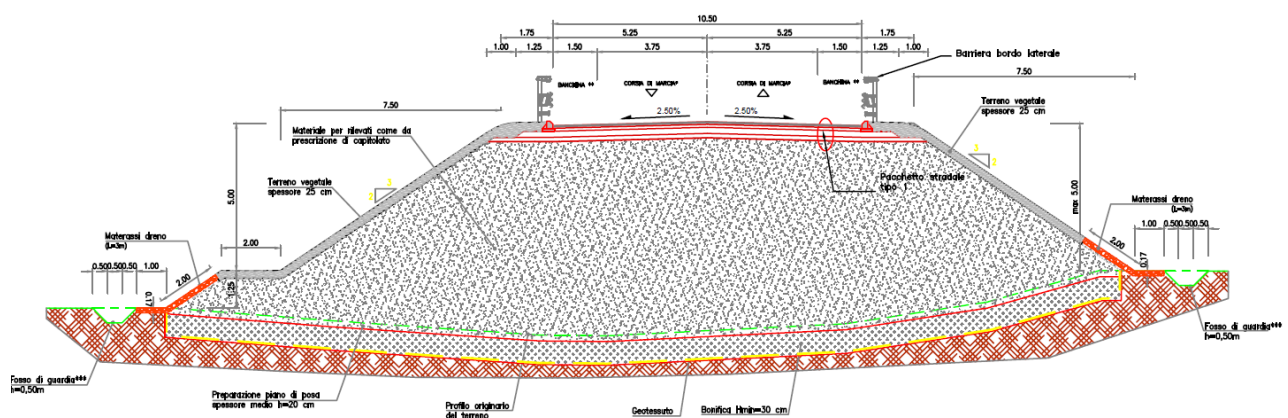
Sezione tipo del rilevato e protezione di 3m con materassi Reno su geotessuto
